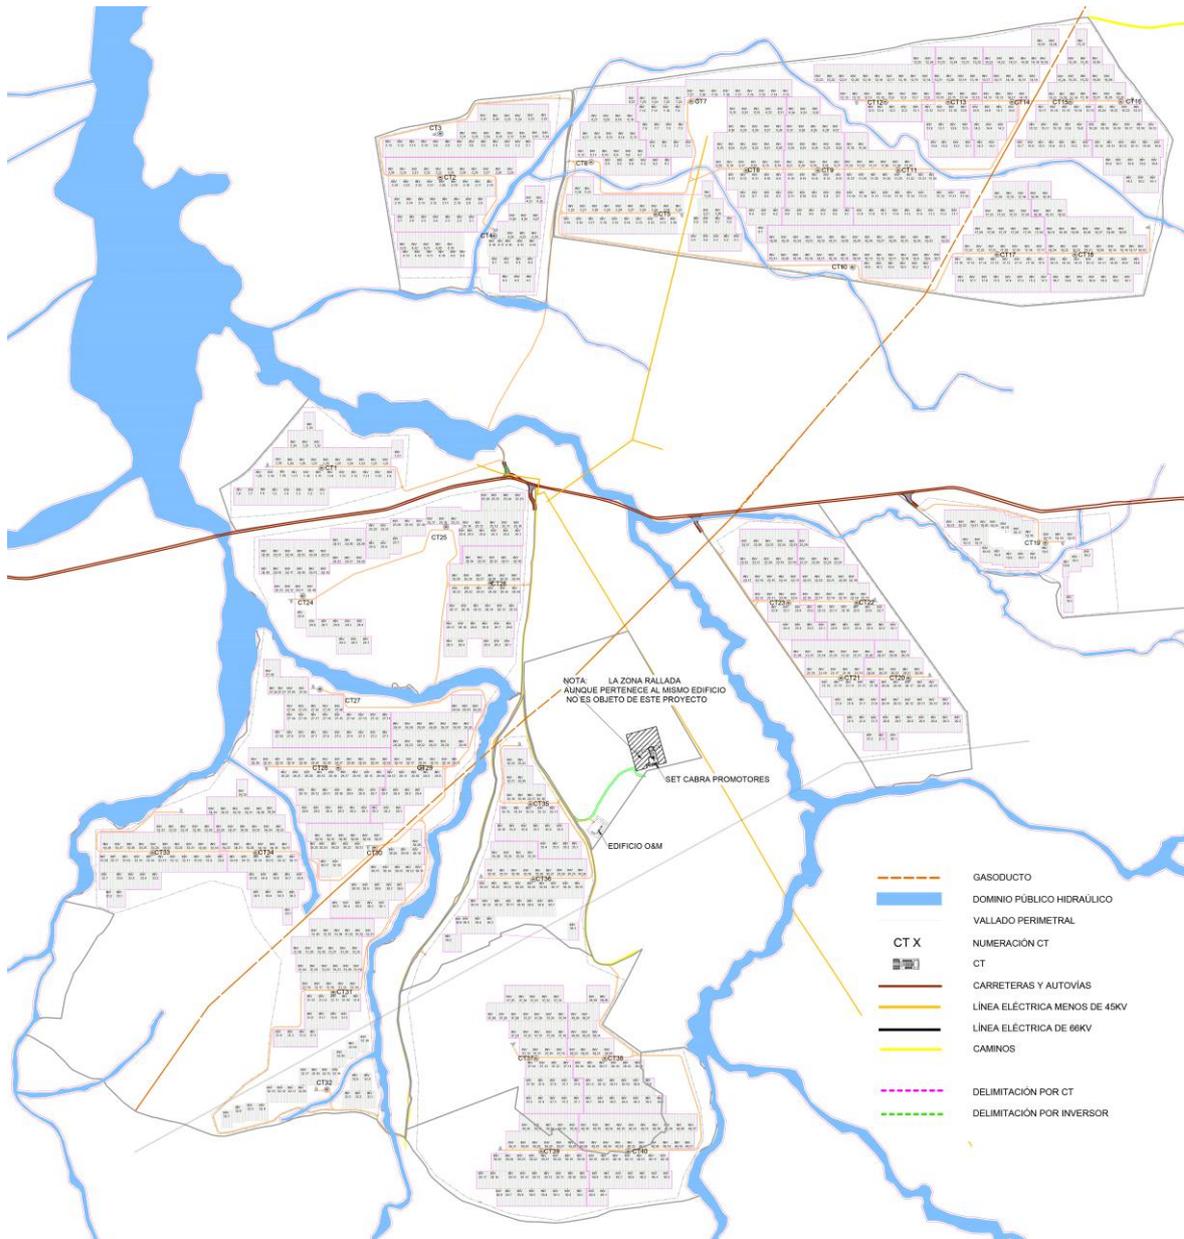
Layout General de la Planta Solar Fotovoltaica.
